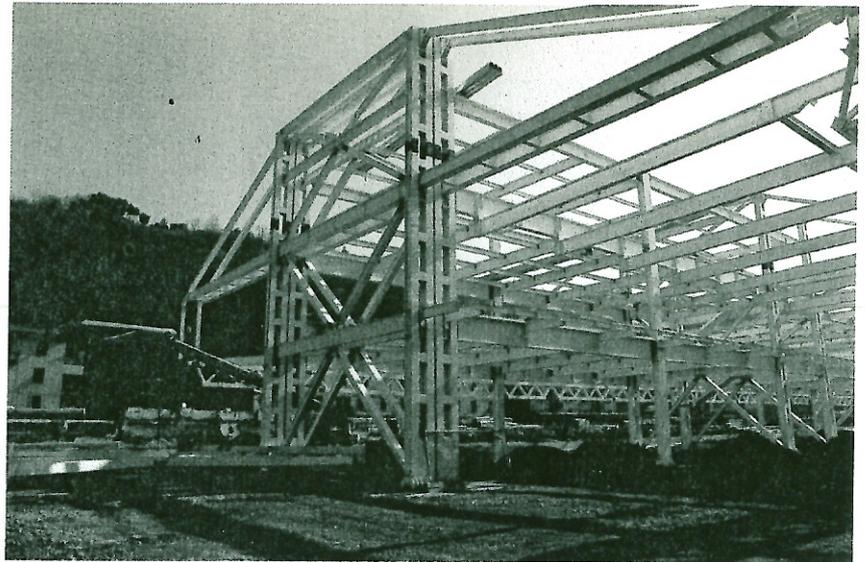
Telai strutturali e particolare attacco plinto di fondazione
